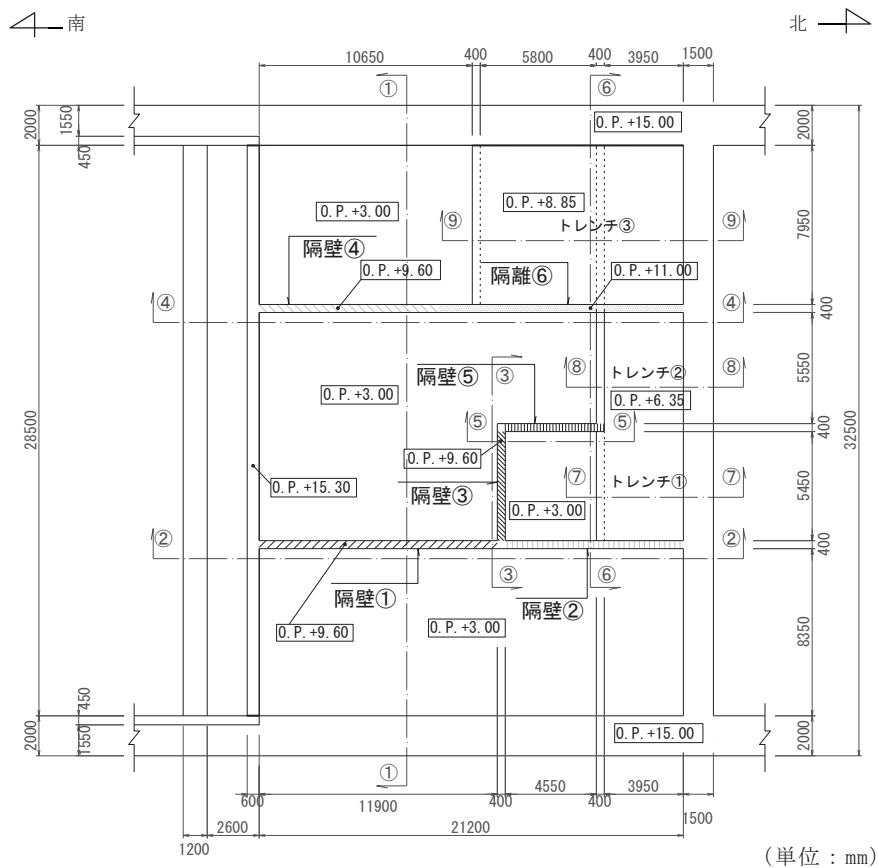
海水ポンプ室補機ポンプエリアの平面図
